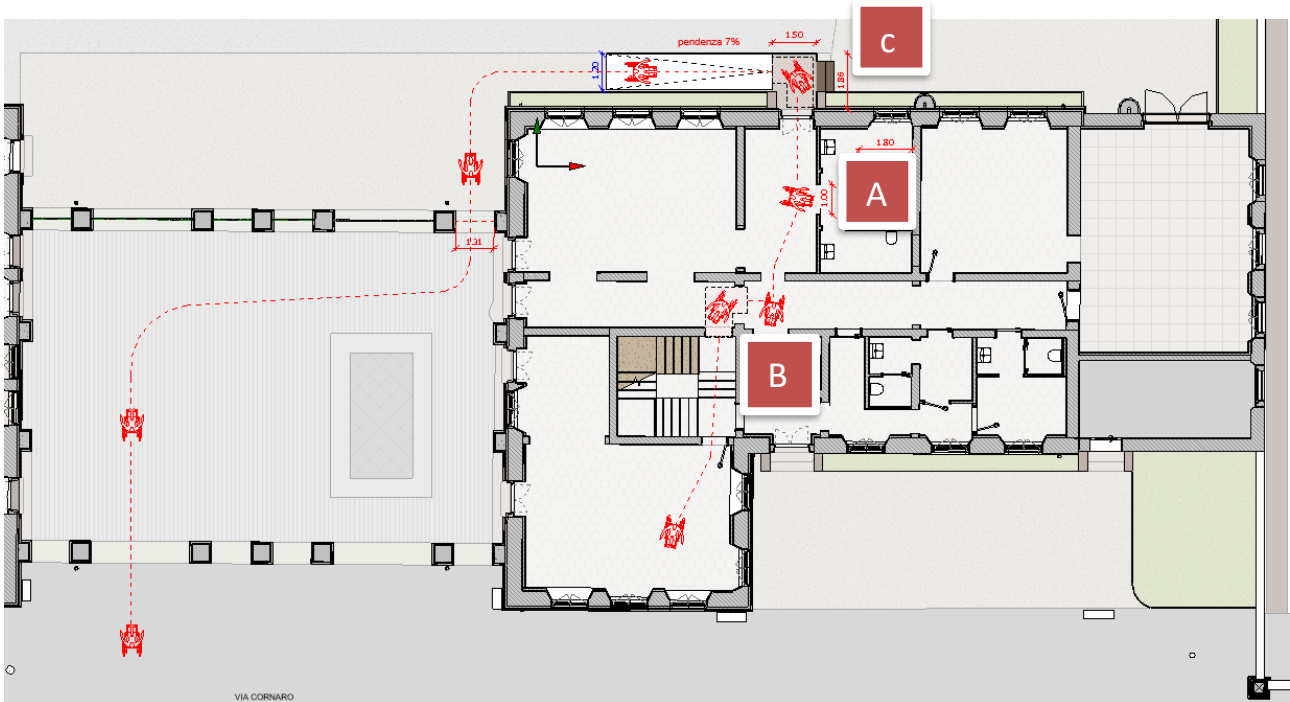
Estratto tavola di progetto – Edificio B pianta piano terra.
